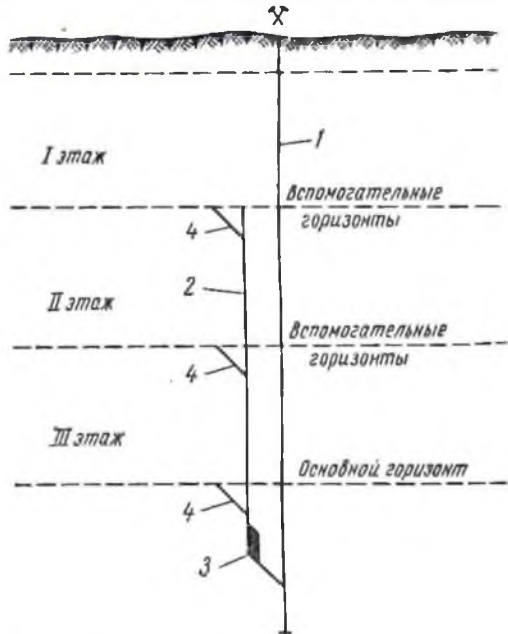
Схема вскрытия строенными этажами (вертикальный разрез):
